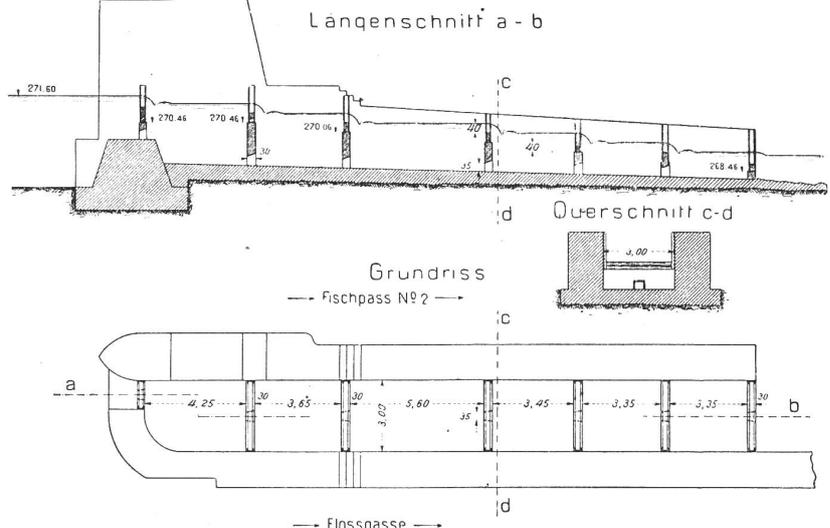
Stauwehr des Elektrizitätswerkes Rheinfelden. Grundriss und Längenschnitt durch die Fischstreppe 2 b. Maßstab 1 : 300.
